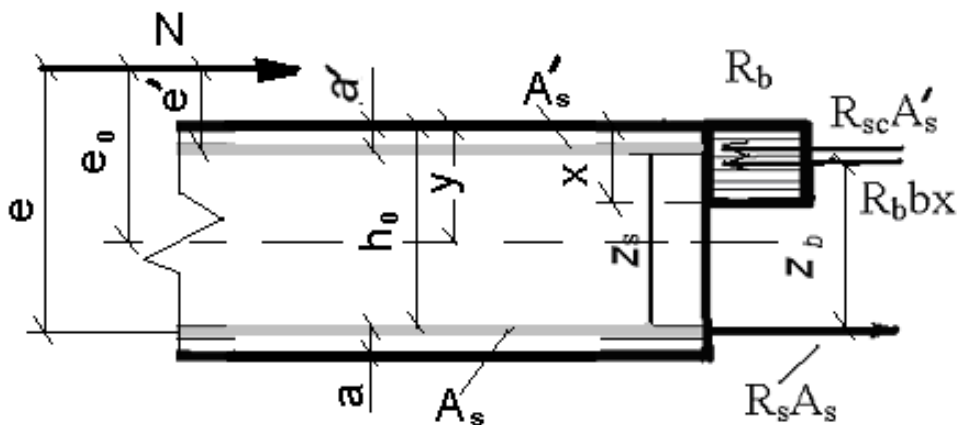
Схема зусиль, які виникають у балці з подвійною арматурою
